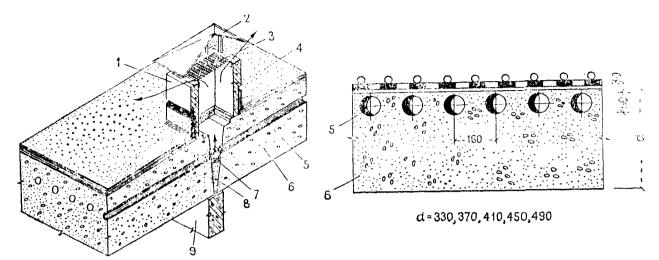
Коиструкция вентилируемого бесчердачного покрытия с отверстиями в несущей легкобетонной плите
